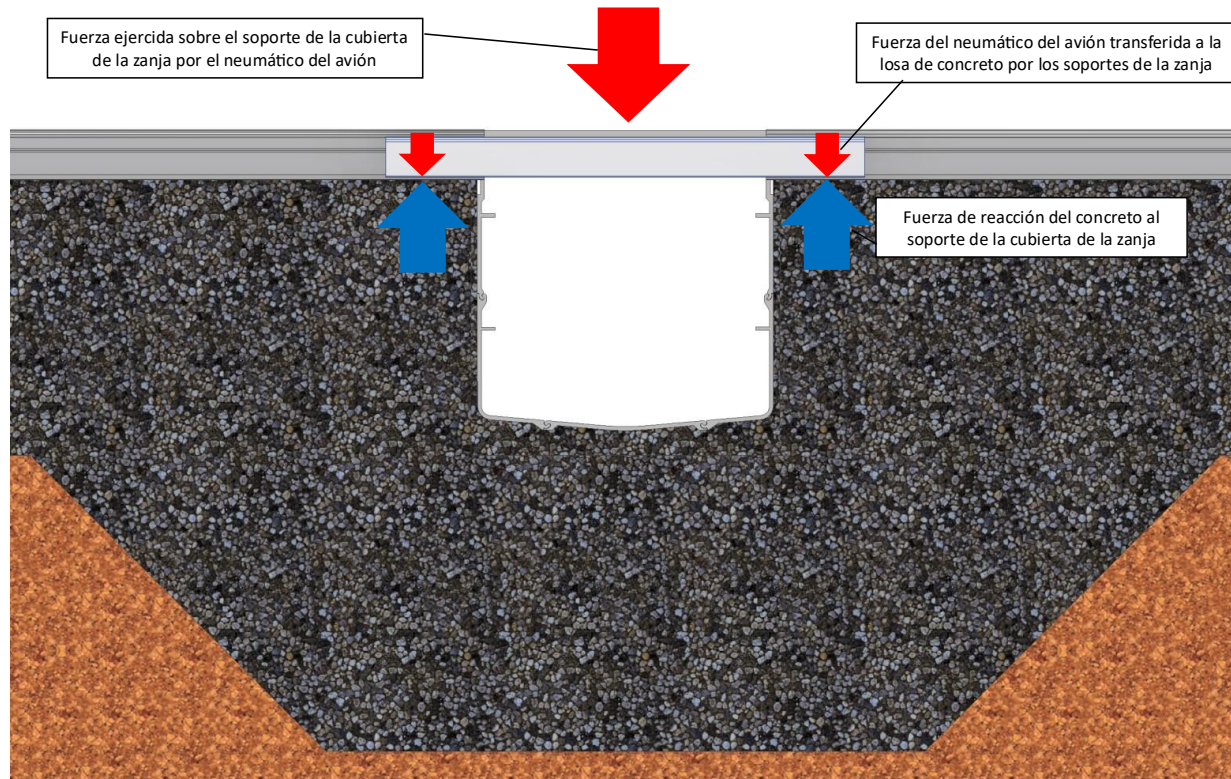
Representación de una zanja de aluminio y una losa de concreto que muestra la fuerza transferida del neumático de la aeronave al concreto.
